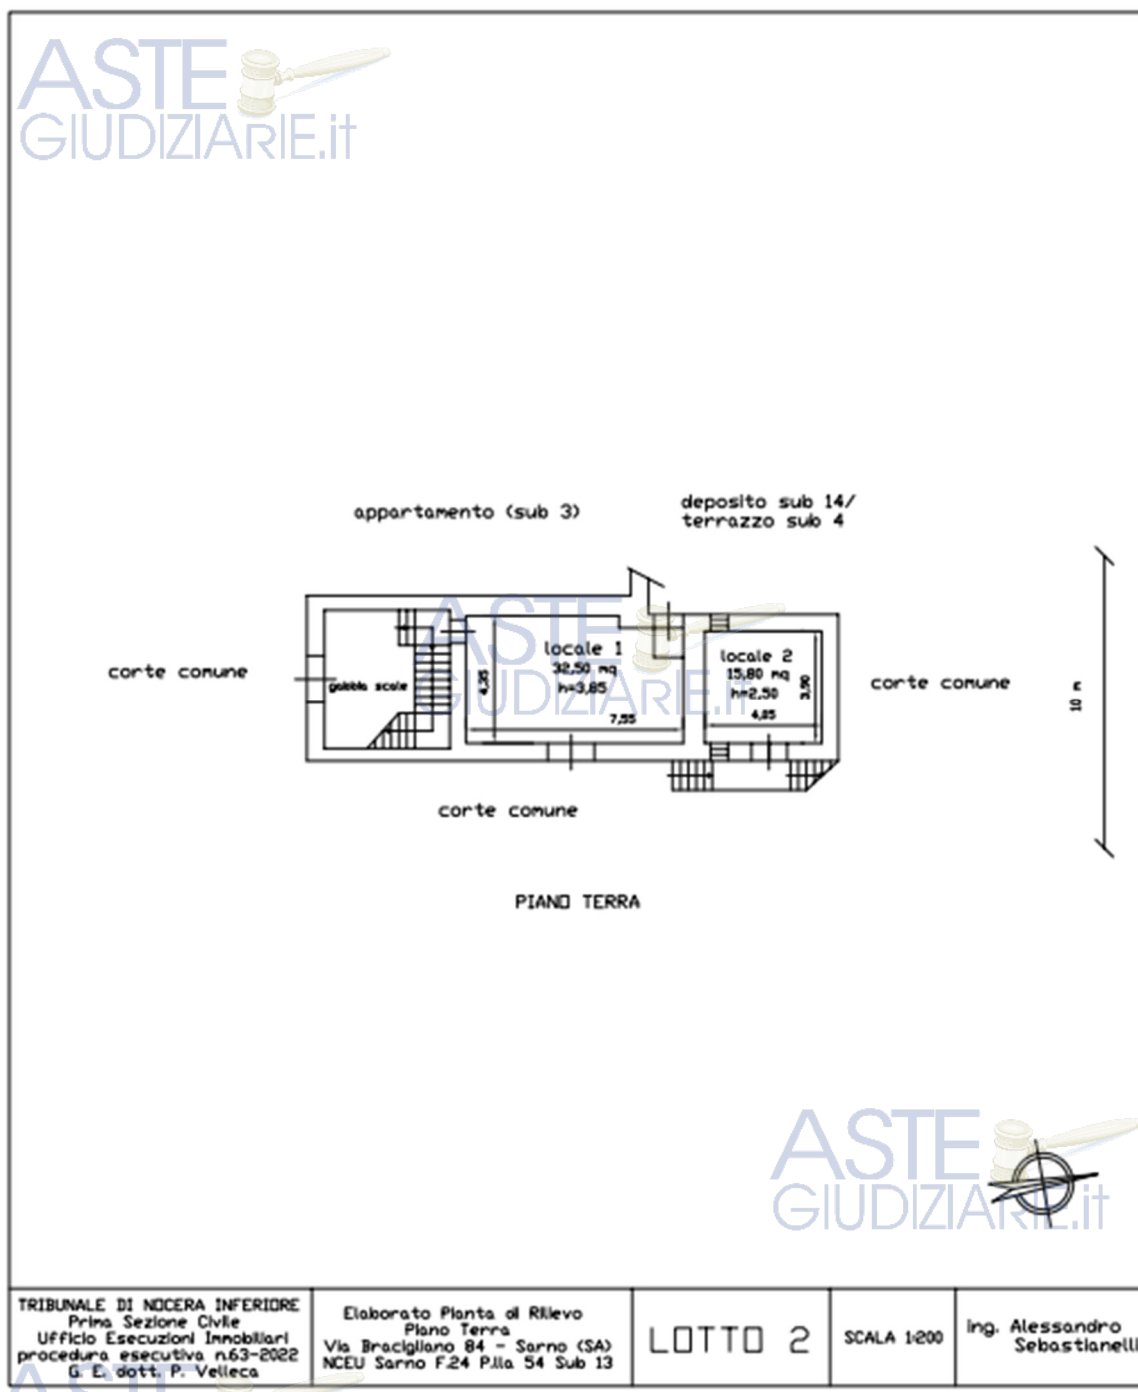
Planimetria stato di rilievo deposito lotto 2 (F.24 p.Illa 54 sub 13)
